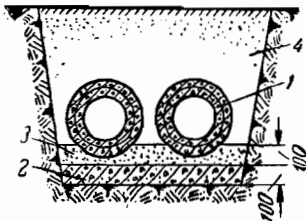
Бесканальный теплопровод в армопенобетонной оболочке конструкции Ленэнерго.
